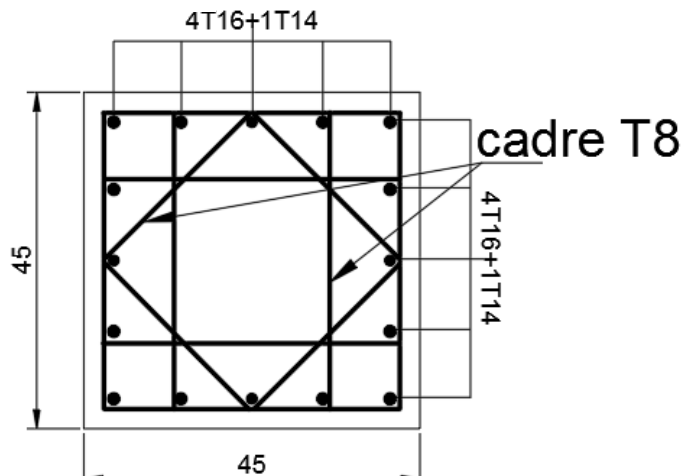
Ferrailage du poteau du 6^{ème} + 7^{ème}+8^{ème}
